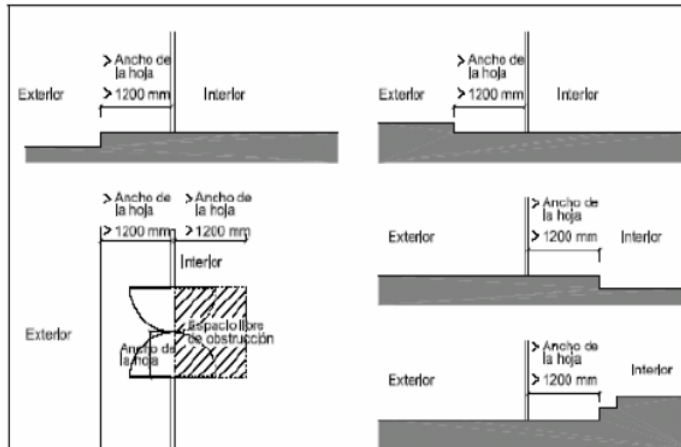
Distancia entre la puerta de acceso y el escalón más próximo
